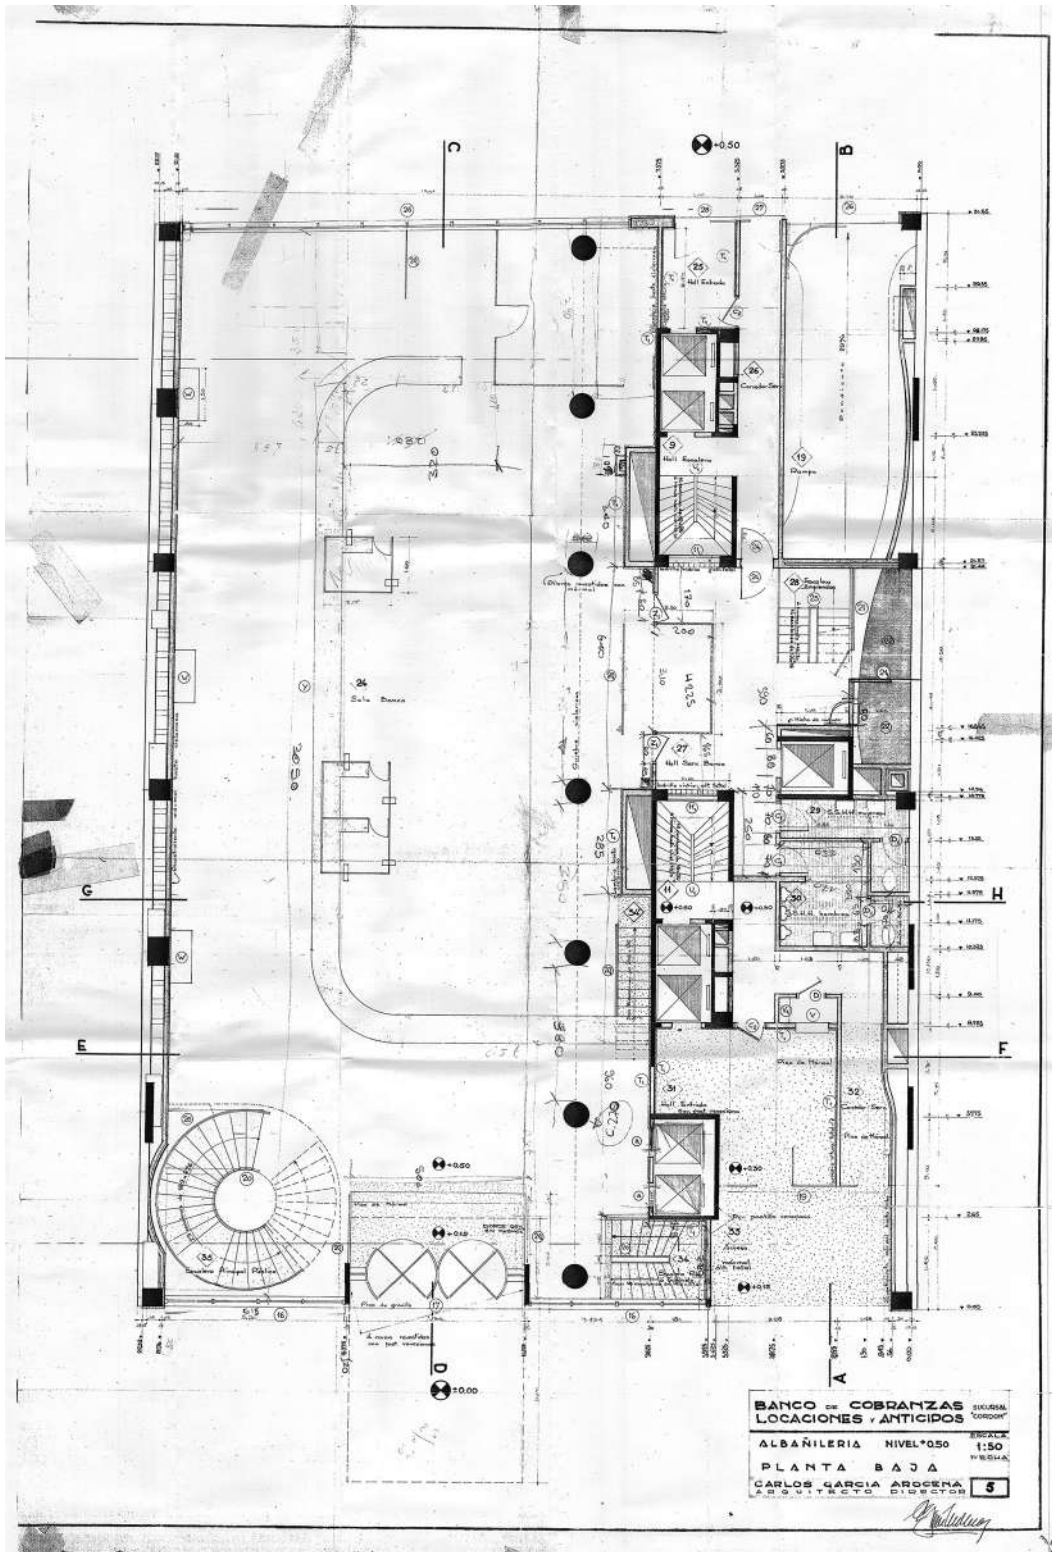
Planta baja del proyecto del BCLA presentado a la IMM en 1959.
